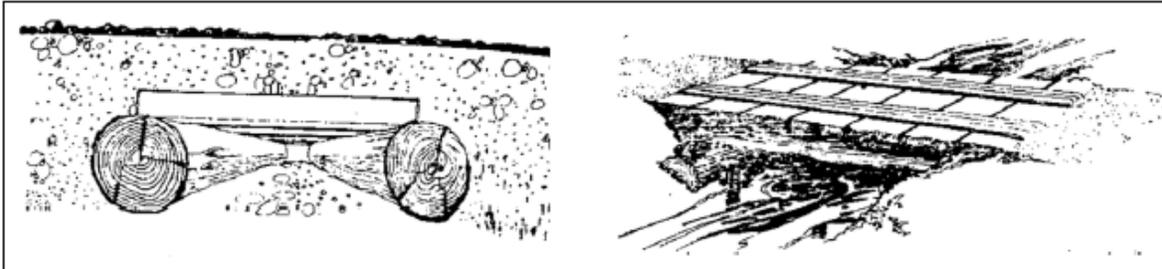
Alcantarilla y puente (transito ligero) de madera
